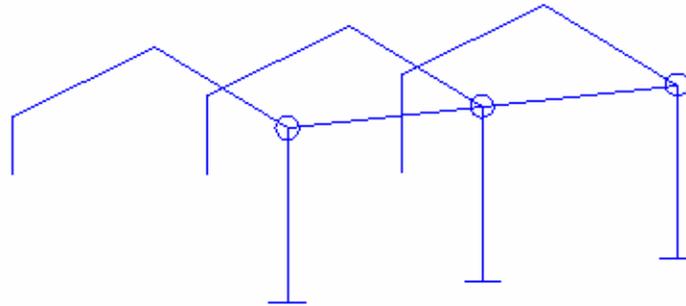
Vigas de bordadura, que unem os pórticos lateralmente, devem ter ligações rígidas
